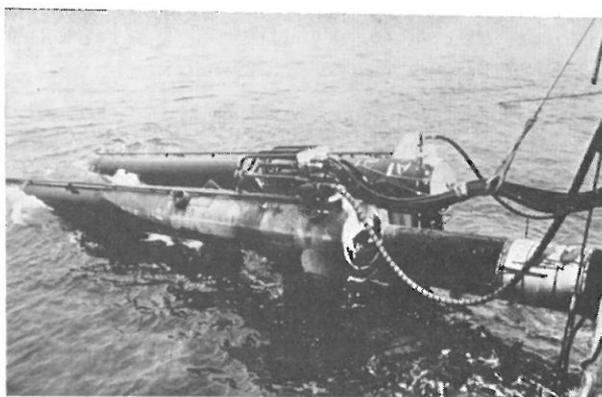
Même pipe-line sur sa rampe de lancement, pour pose dans 70 m d'eau.
